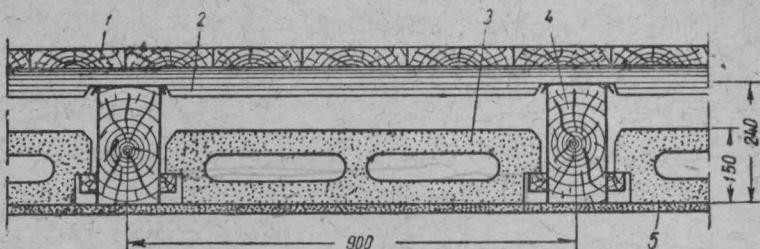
Перекрытие по деревянным балкам с заполнением из шлакобетонных камней:
